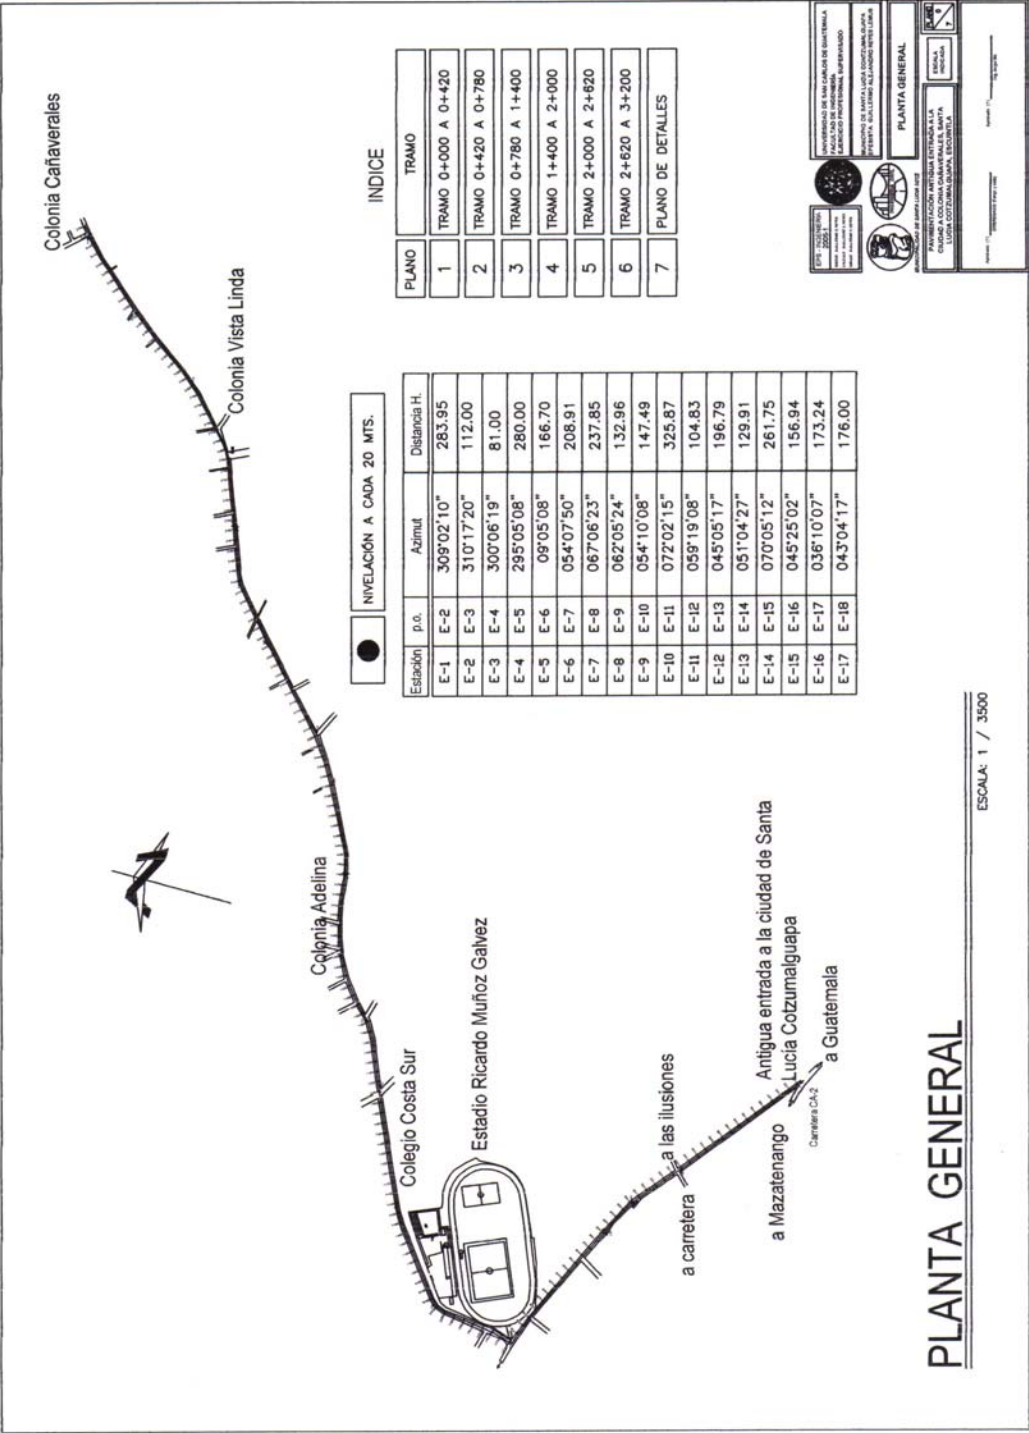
Calle a pavimentar, Santa Lucía Cotzumalguapa
